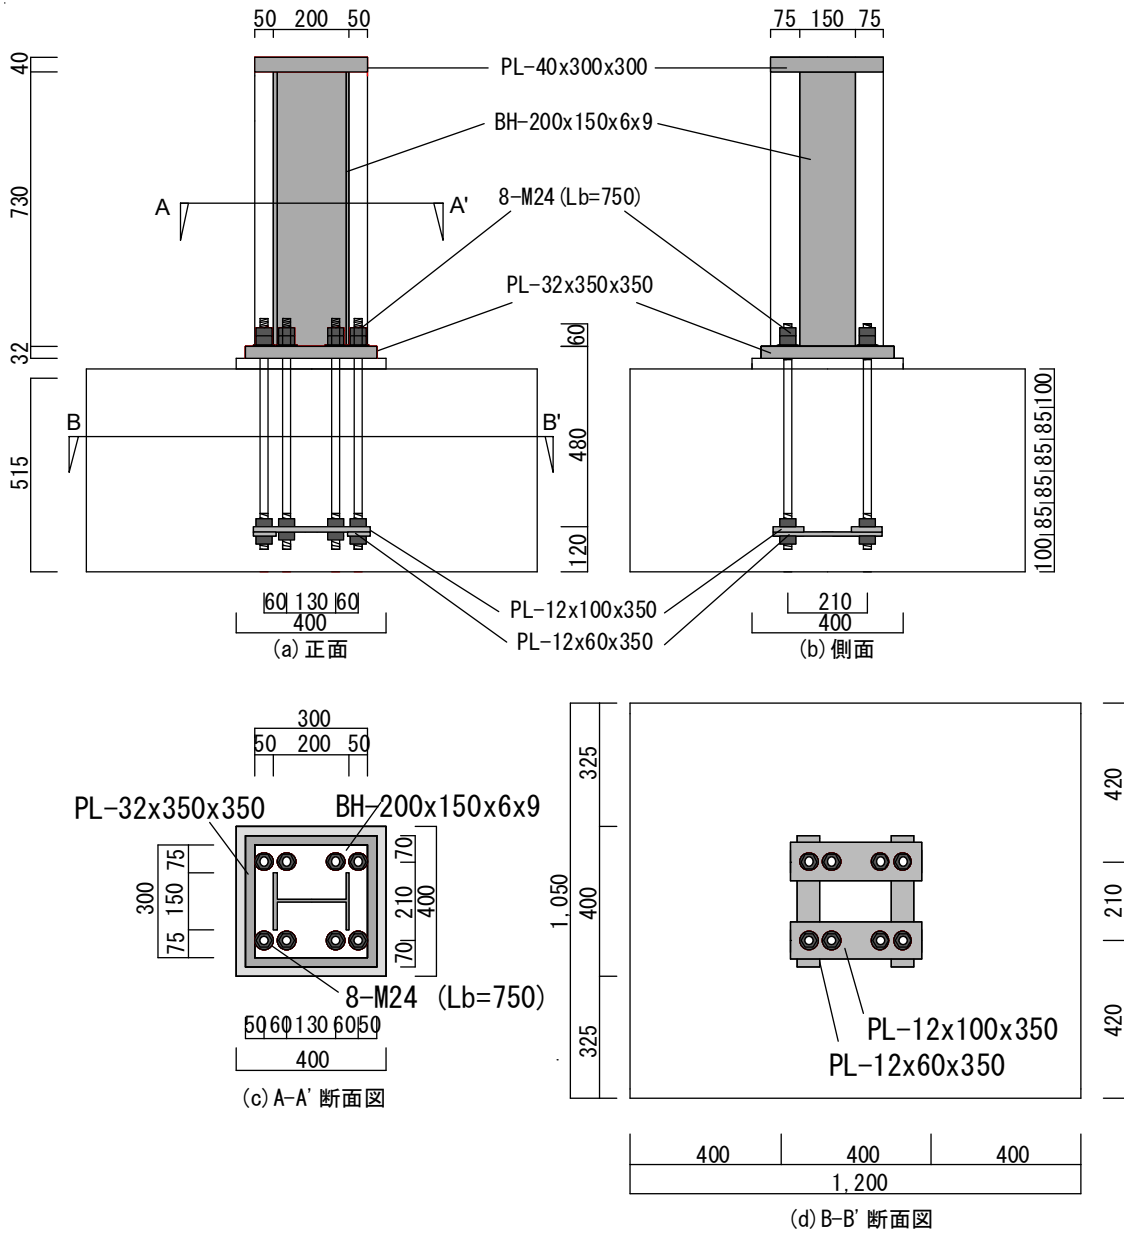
試験体鉄骨および AB 配置状況 (試験体 NO)
